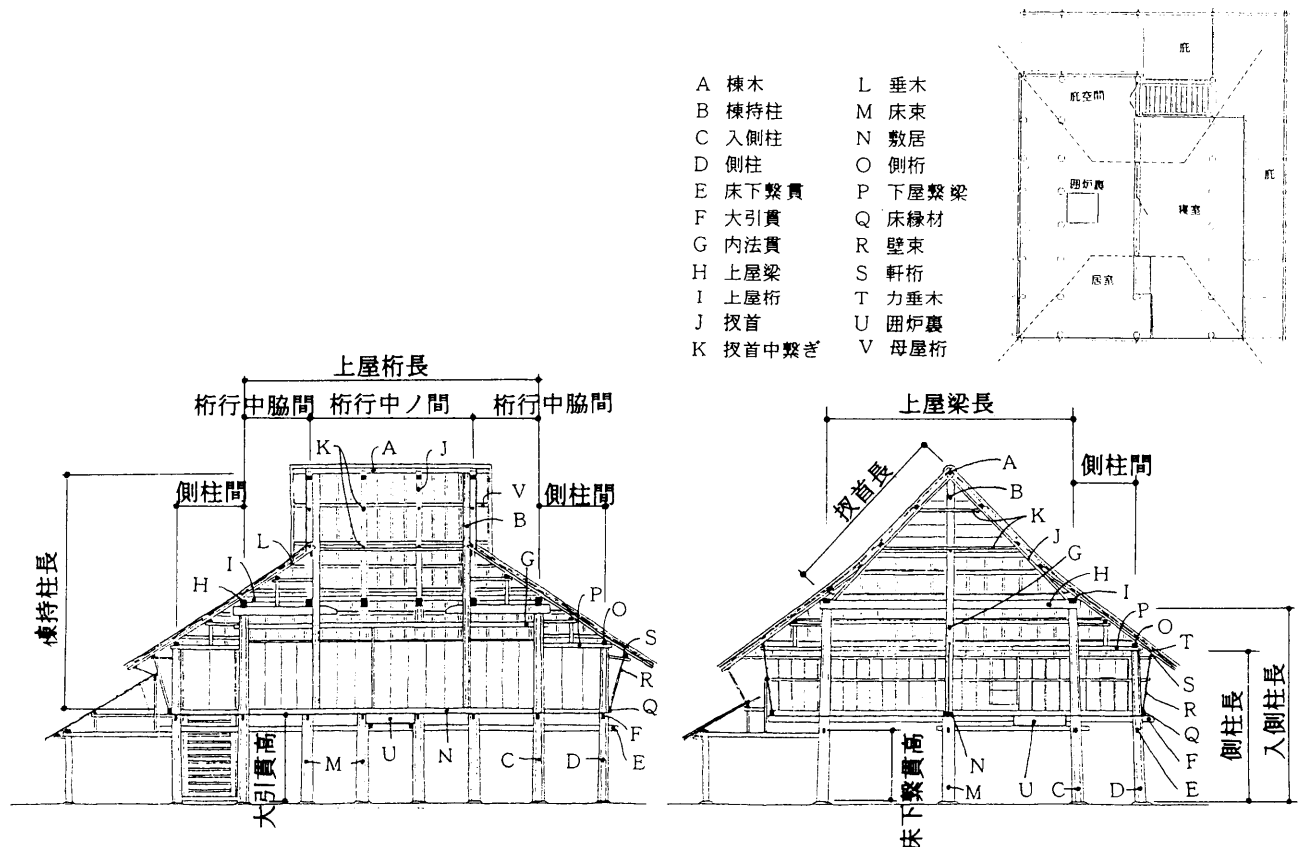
蔓炸20 平面図, 梁行・桁行断面図
